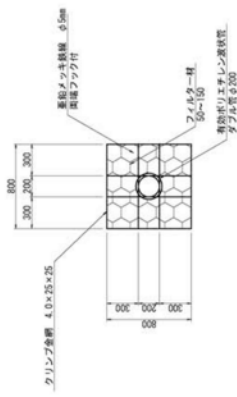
(1) 地下水集排水施設設計画平面図 (竹鼻地区理立地)
